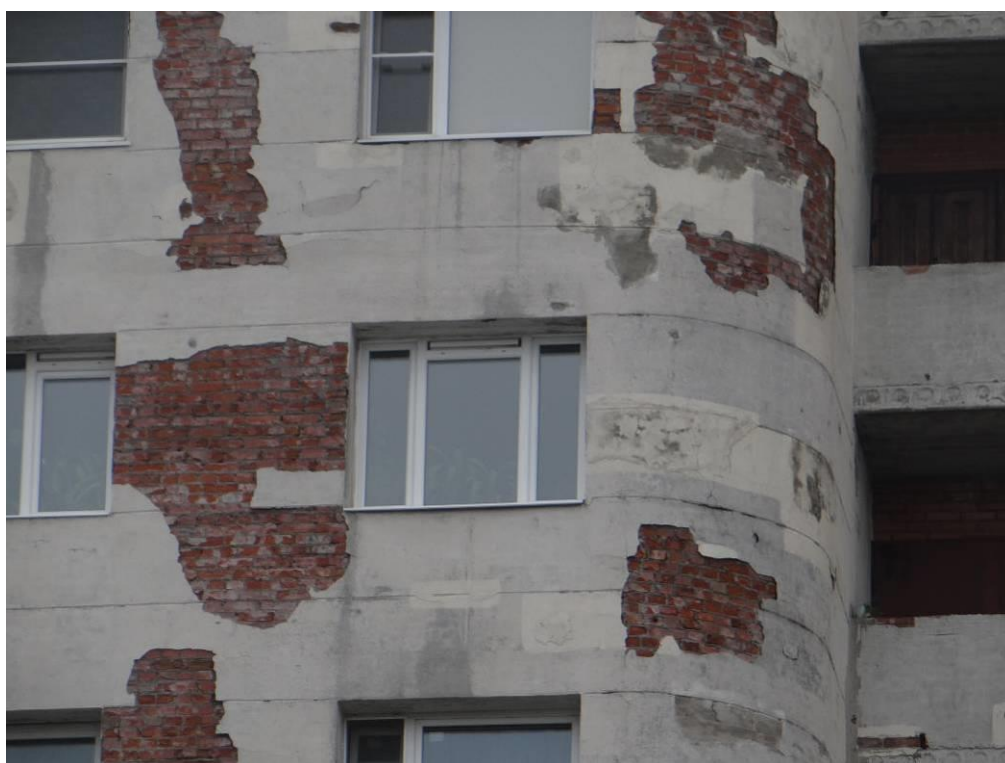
Фрагмент фасада по оси «А» на участке в осях «3» - «4» в уровне 12 этажа. Следы увлажнения поверхностей фасада, приуроченные к подоконным отливам. Сети разнонаправленных трещин в штукатурном покрытии. Участки обрушения штукатурного покрытия. Морозное разрушение материалов кирпичной кладки.
